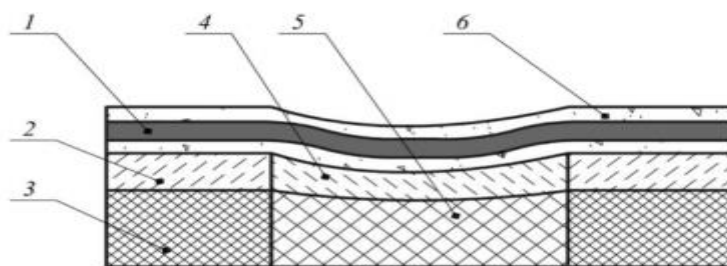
Схема осадки наземного нефтепровода: 1 – нефтепровод; 2 – оттаявший непросадочный грунт; 3 – мерзлый непросадочный грунт; 4 – оттаявший просадочный грунт; 5 – мерзлый просадочный грунт; 6 – песчаная насыпь
